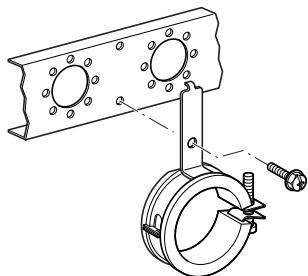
Монтаж хомута отводящей трубы Geberit для монтажных панелей
